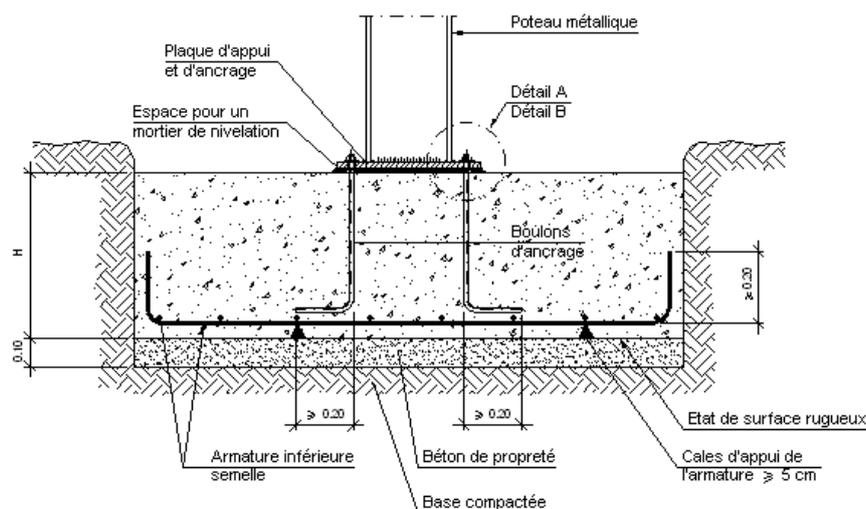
Pied de poteau articulé. Source : JT COTITA RENFORCEMENT PARASISMIQUE, STRUCTURES MÉTALLIQUES. P16
